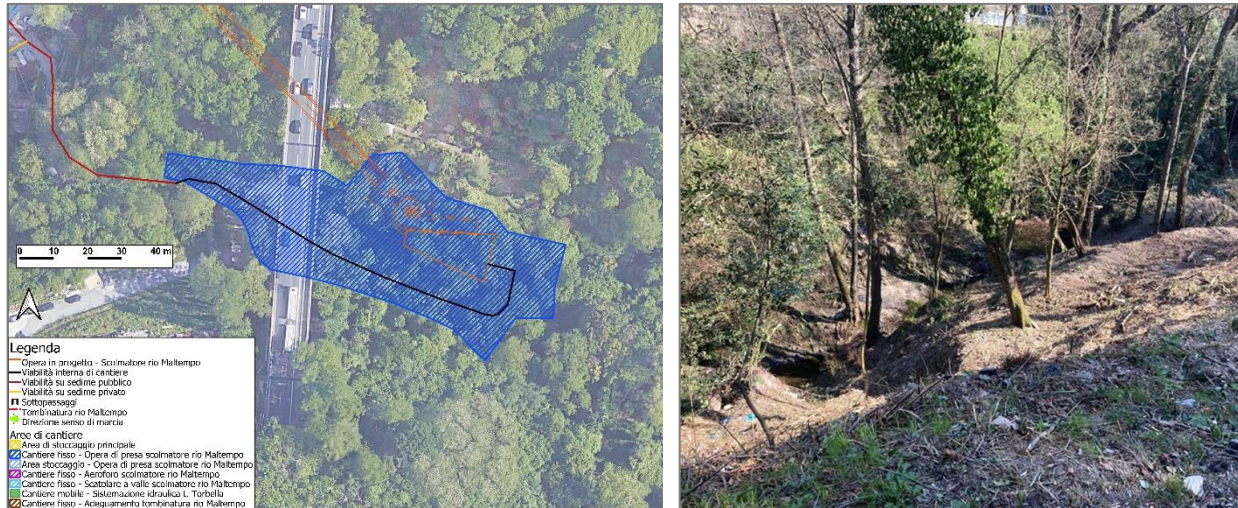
Inquadramento di dettaglio dell’area dalla planimetria di cantiere (a sinistra) e stato attuale della prevista area di cantiere fisso – opera di presa scolmatore rio Maltempo (a destra)
